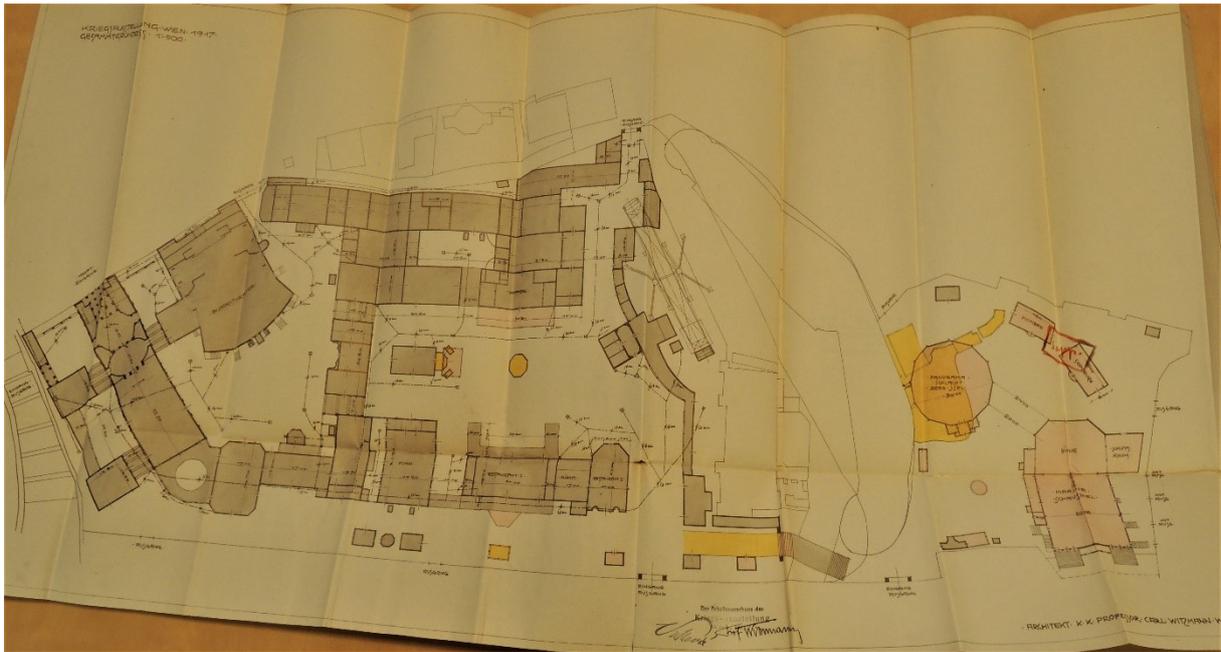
Grundriss des Ausstellungsgeländes mit den für 1917 geplanten baulichen Änderungen
